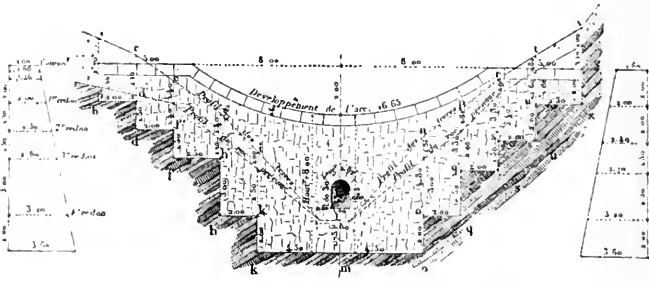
Barrage en Maçonnerie mixte. — Élévation dégagée des terres.
